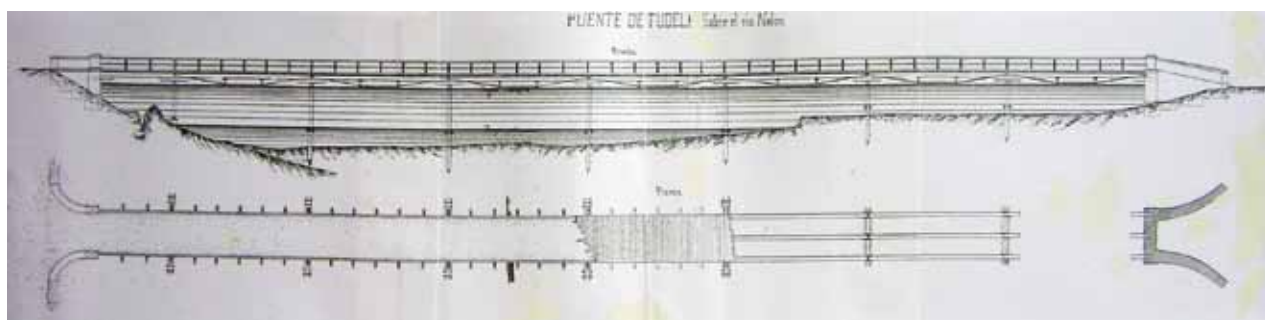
Puente de madera sobre el río Nalón en Tudela, Oviedo. (D)
